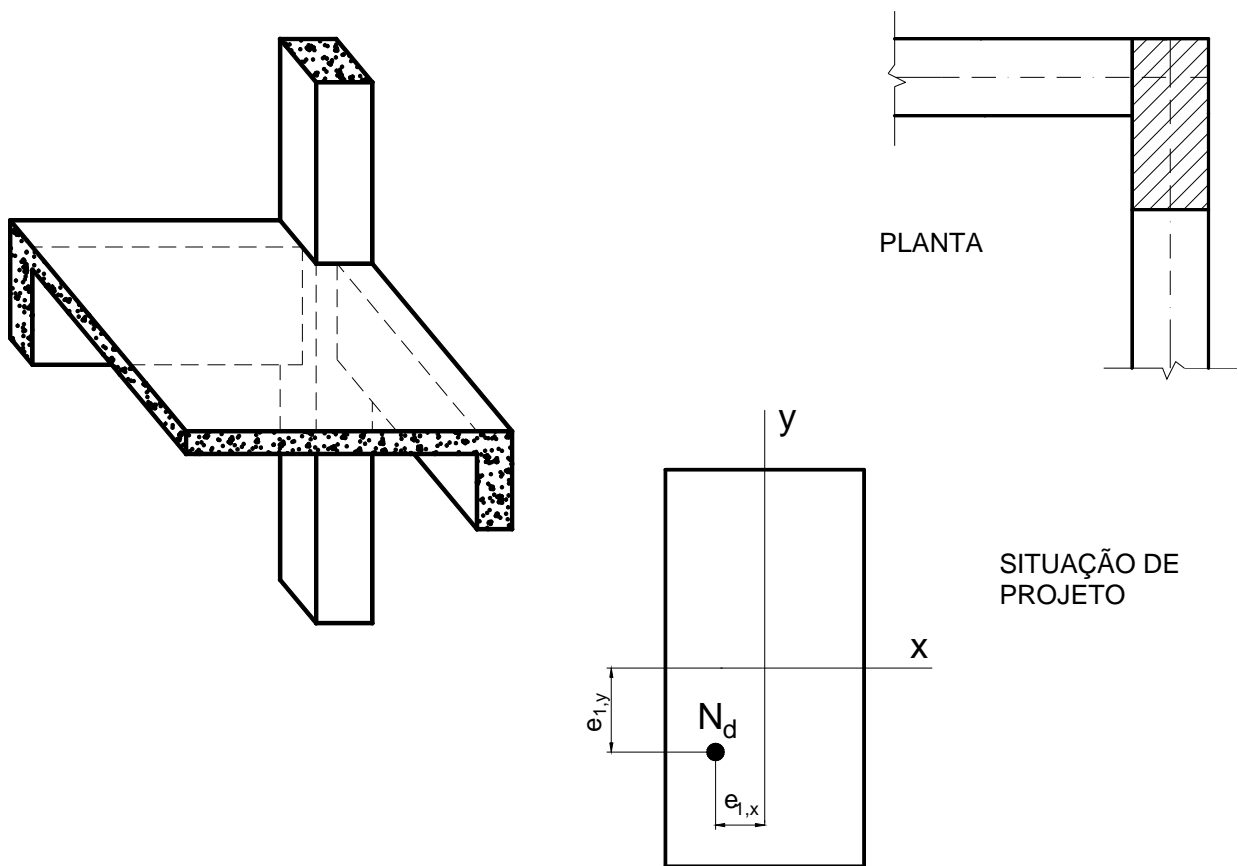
Arranjo estrutural e situação de projeto dos pilares de canto.
